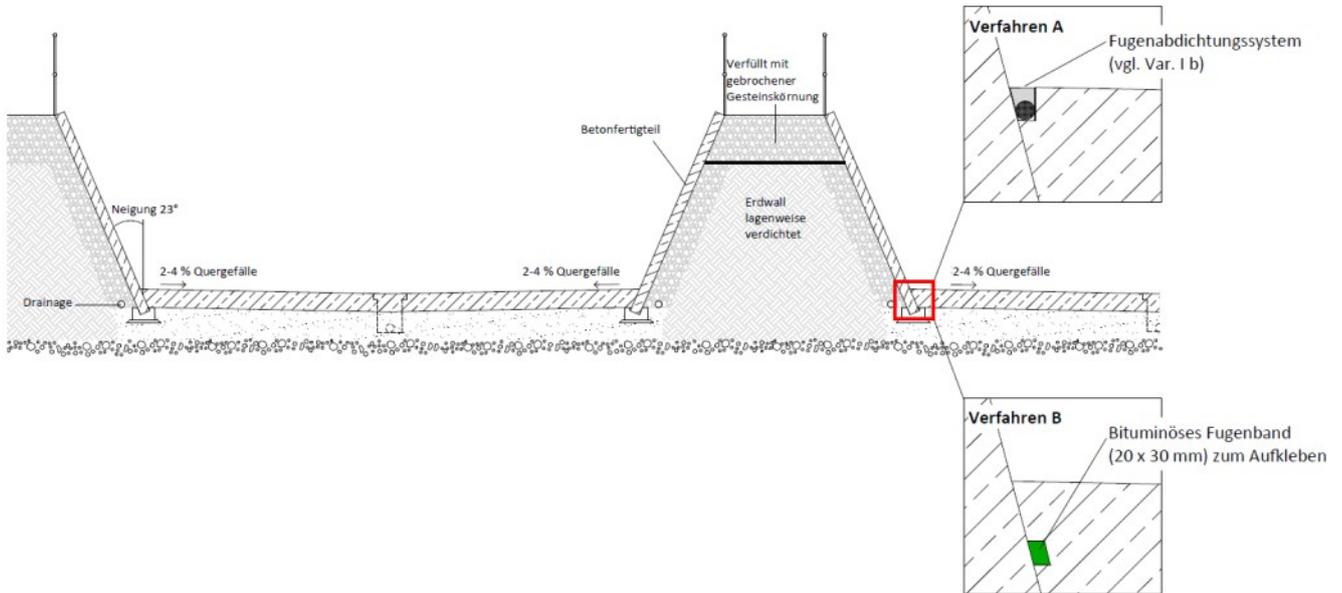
Ort beton - Betonfertigteil (Traunsteiner Wand); weitere Details siehe abZ/aBG, Anlage 1 - 6
